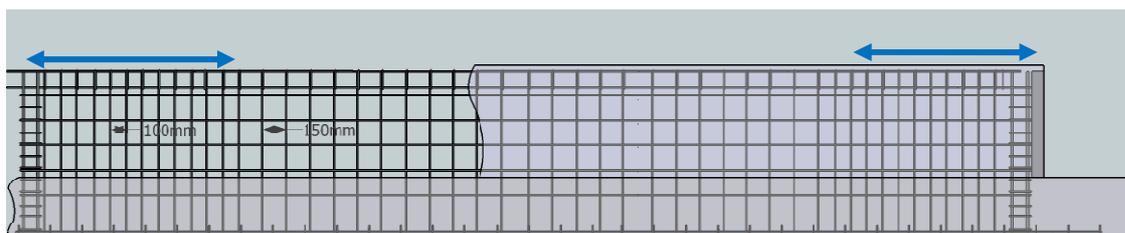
Représentation schématique du principe de ferrailage d'une fondation de type semelle filante (élévation).
